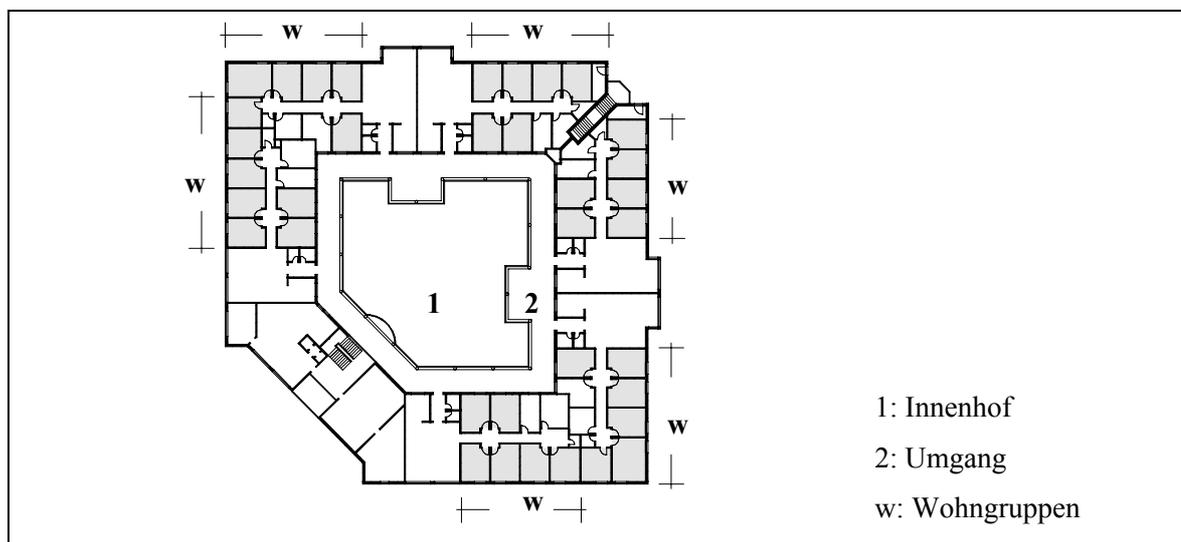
Grundriss Anton-Pieck-Hofje, Haarlem, Niederlande¹⁵⁹
